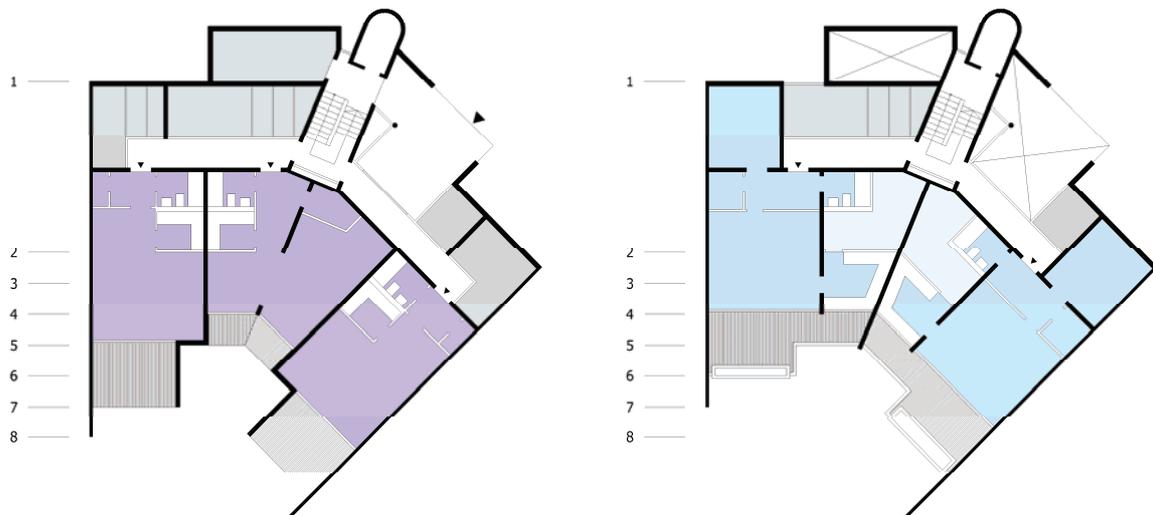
Grundrisse Bestand Typ 14/15/16/17
